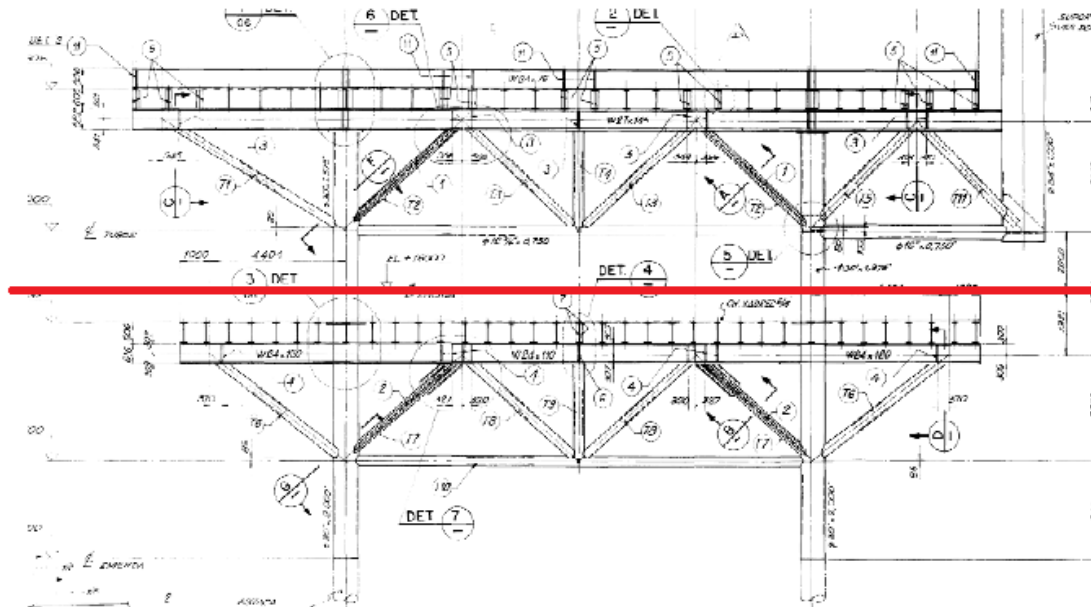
(3) – Vista em corte de PCA-2 indicando o ponto de corte (+16000 – Linha vermelha)
